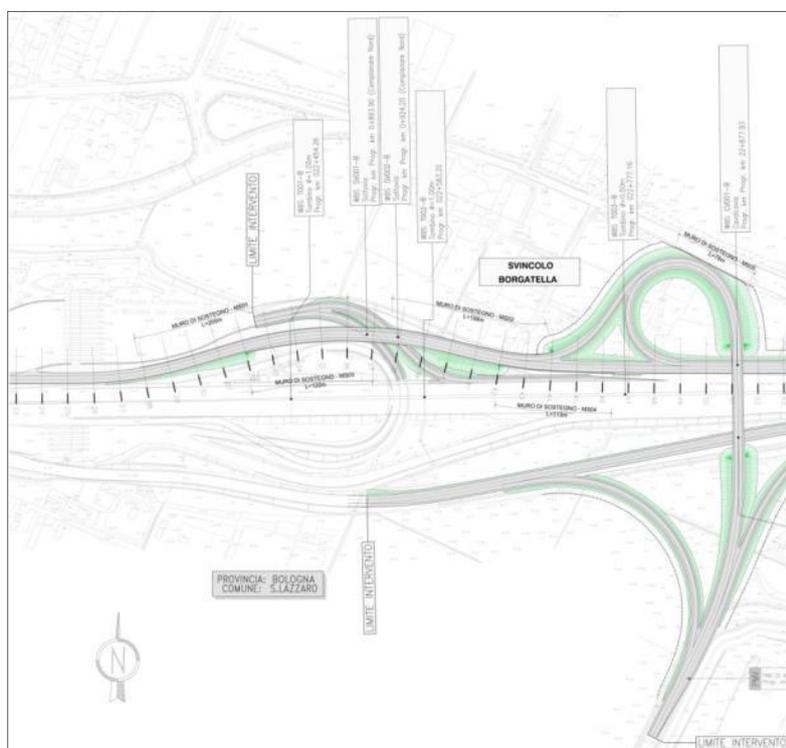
Stralcio planimetrico - Svincolo Borgatella
